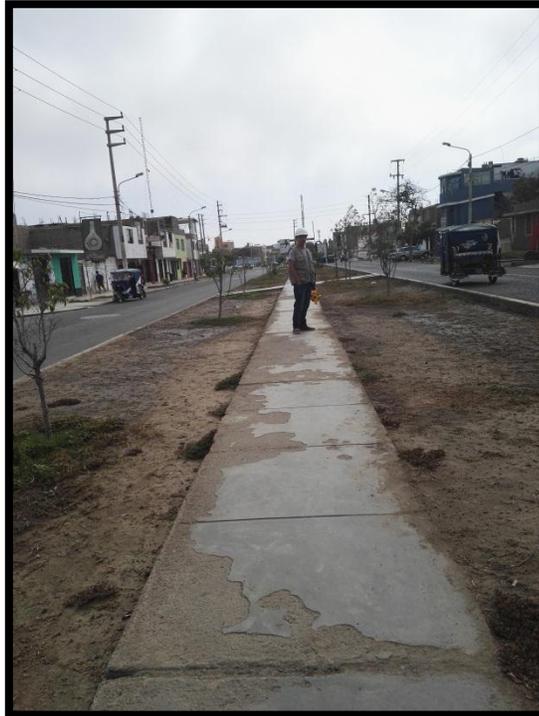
Estado actual de la berma central Avenida Argentina
